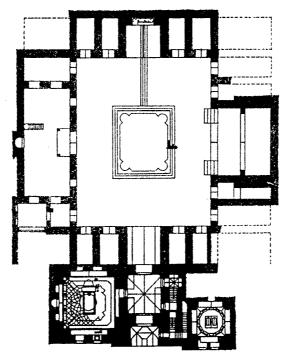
مسقط أفقي لجامع السنانية بدمشق (عن : فلزنجروفتزنجر) .
